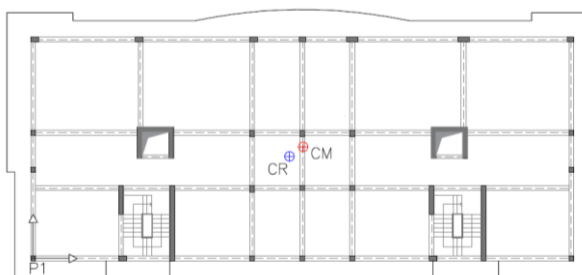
Planta com a localização do Centro de Massa e Centro de Rigidez
